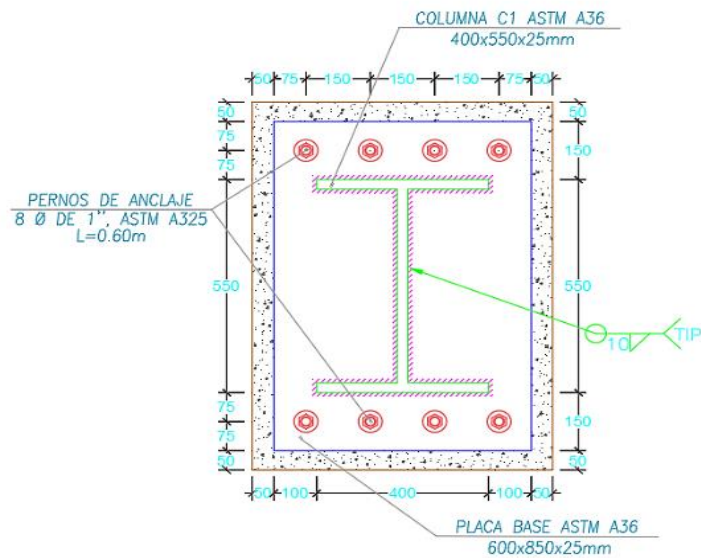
Ubicación de pernos en placa base - Sistema estructural mixto.
